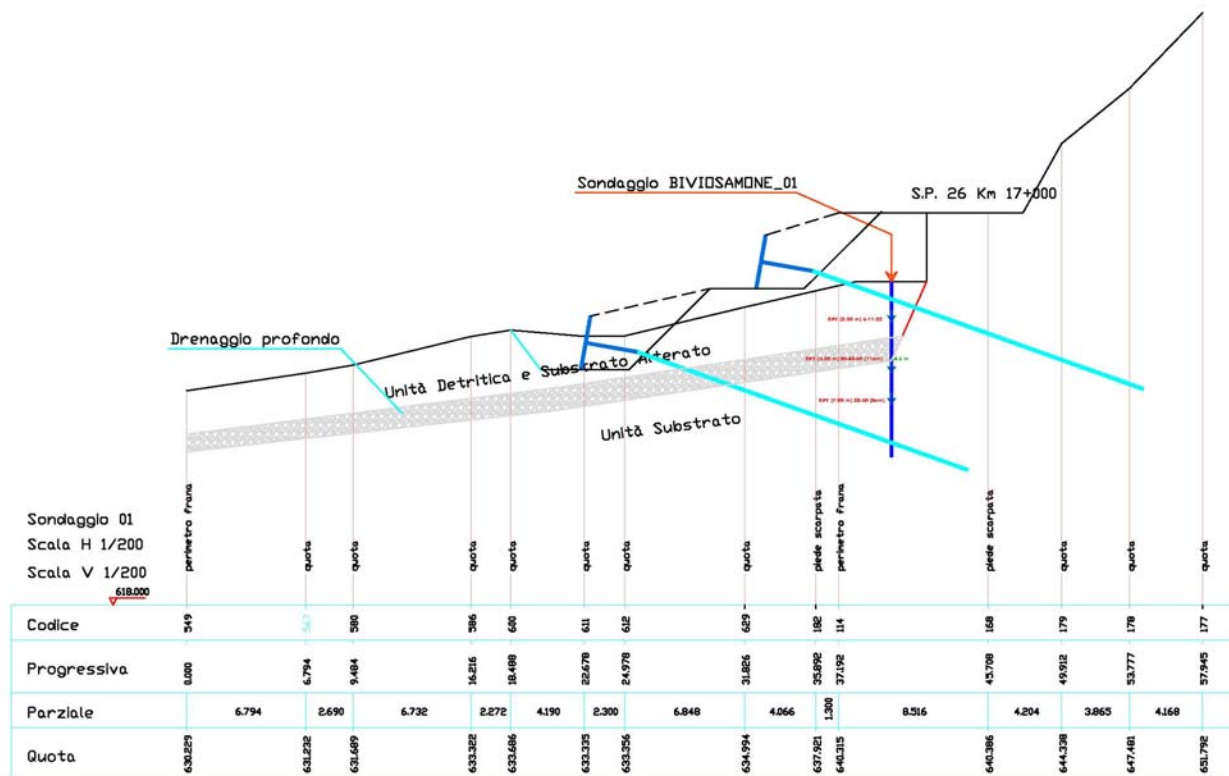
Sezione litotecnica di progetto coincidente con la sezione topografica n. 1
